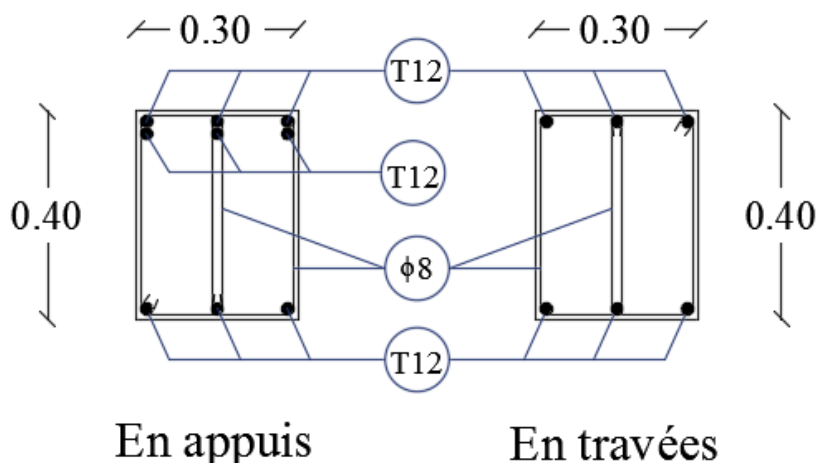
Ferrailage des poutres secondaires (bloc A/B/C/D)
